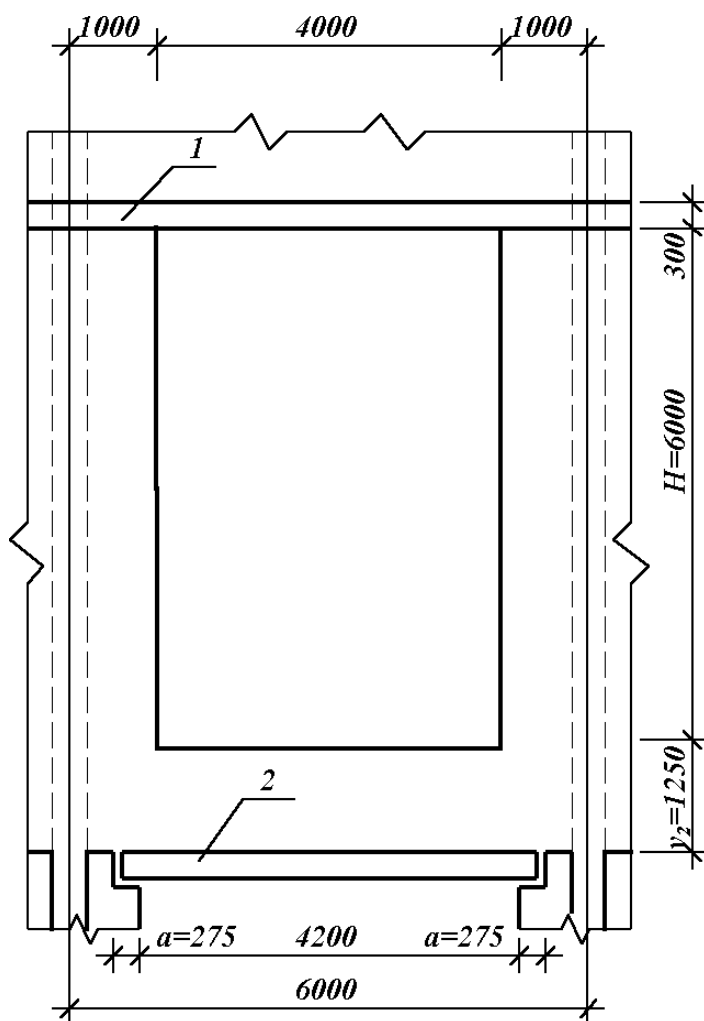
Схема стіни та фундаментної балки: 1 – залізобетонна перемичка; 2 – фундаментна балка
